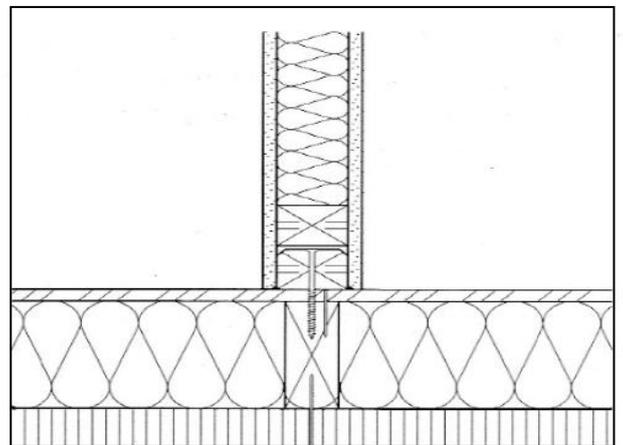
coupe longitudinale d'assemblage mur extérieur/ intérieur
